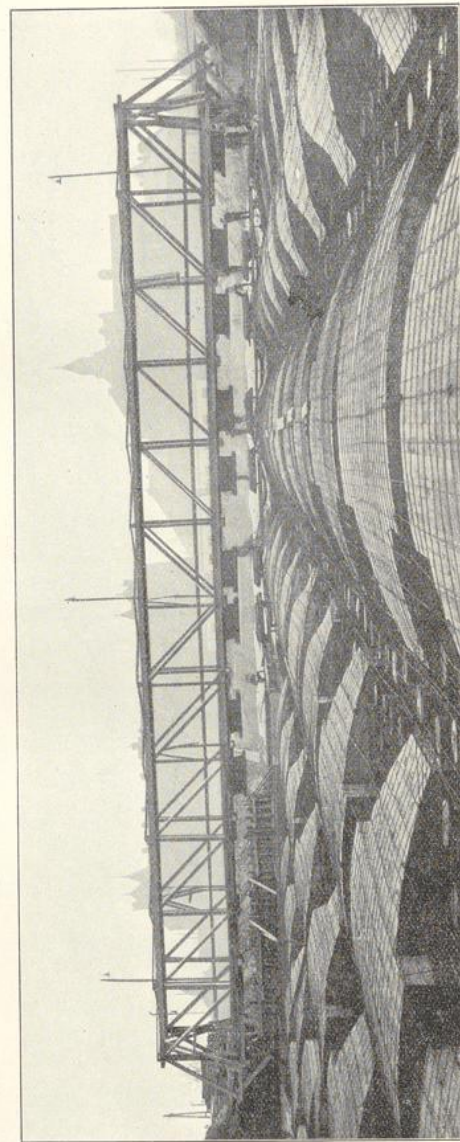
Siemens Bauunion. — Fahrbare Transportbrücke aus Holz.
